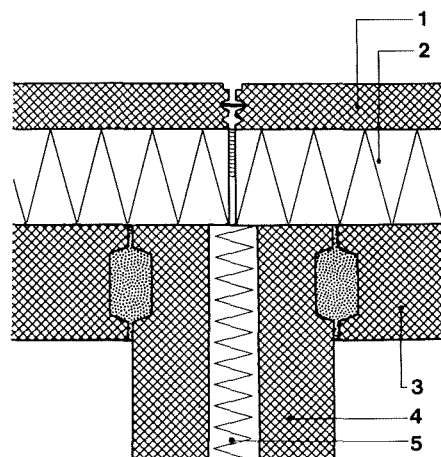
Samling mellem dobbelt murstensvæg og ydervæg af mursten. Vandret snit 1:10.
